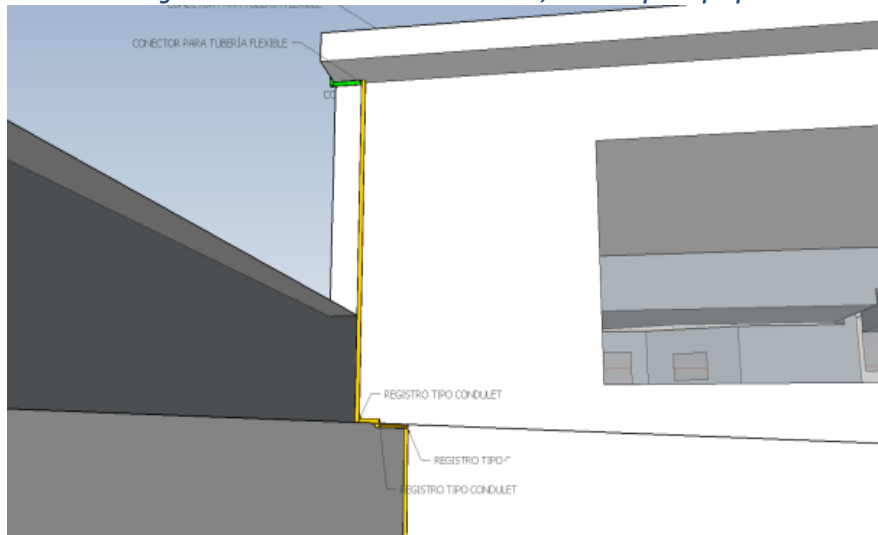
Plano 3D de ruta de tubería, vista 5: aporte propio.
